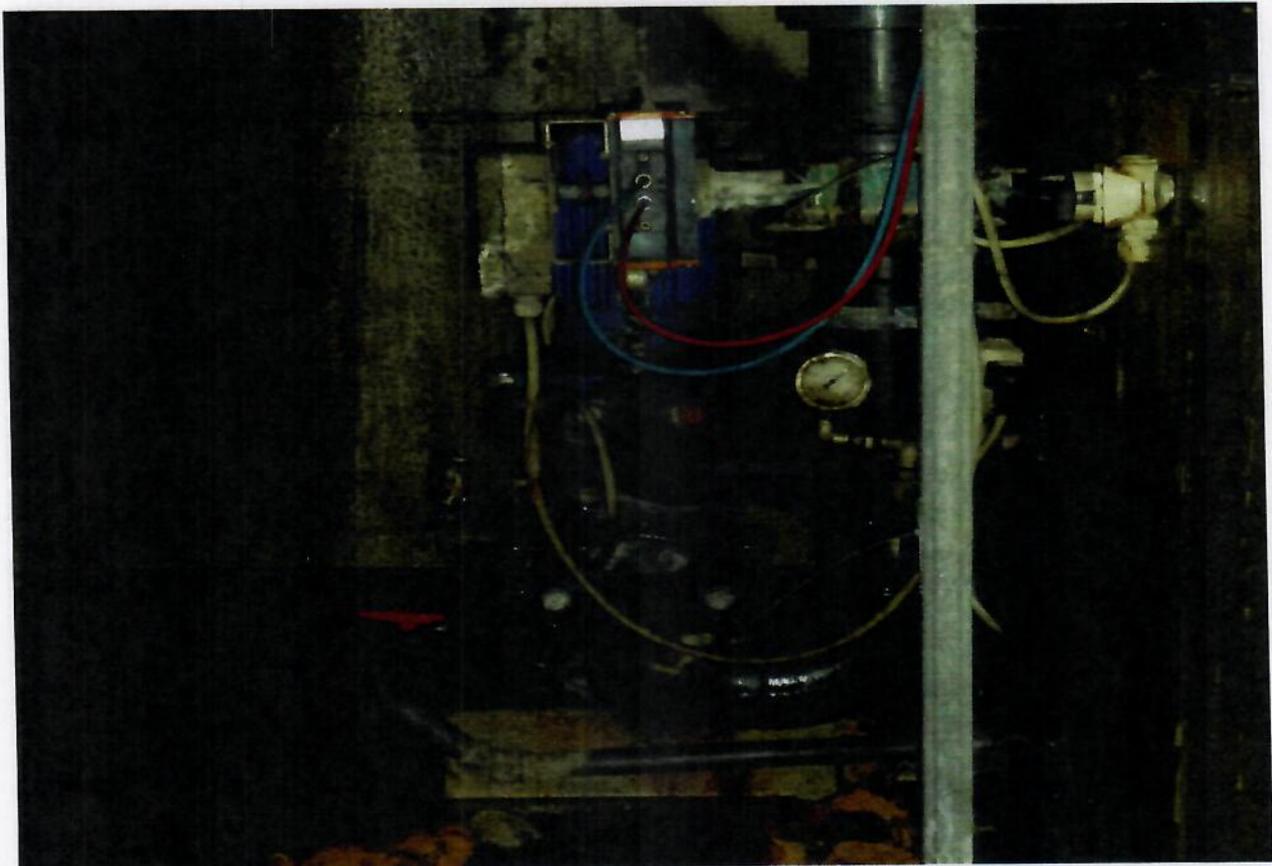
Badewassertechnik 10: Korrosion Anlagentechnik durch Wassereintritt
